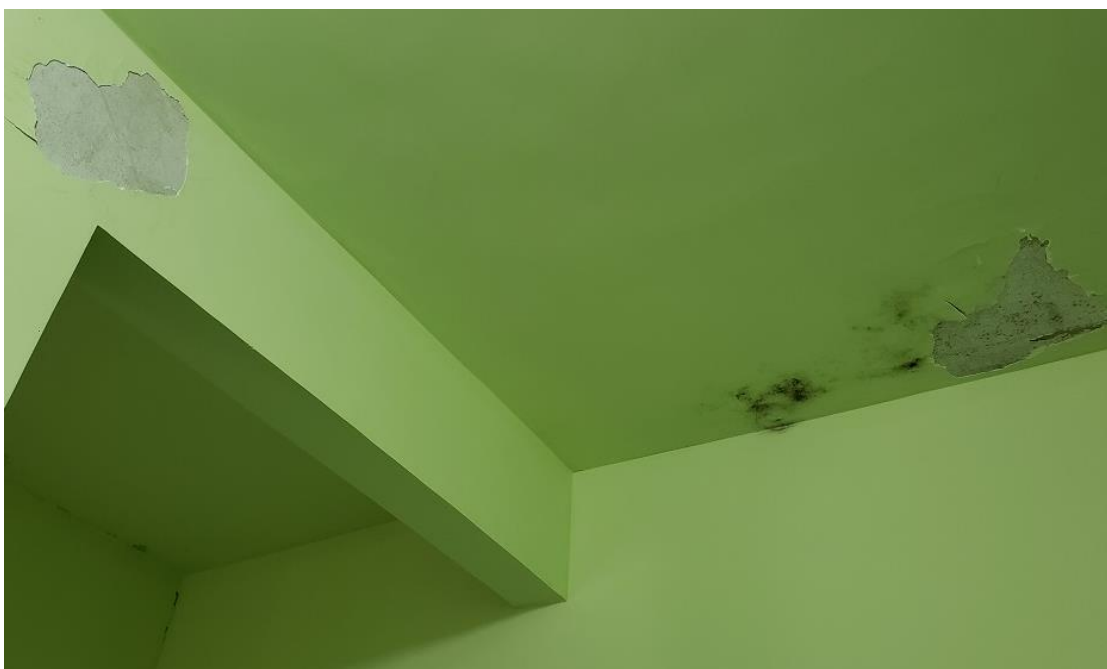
Infiltrações no teto (UBSF Walchimar Santos - Rio Novo do Sul)
